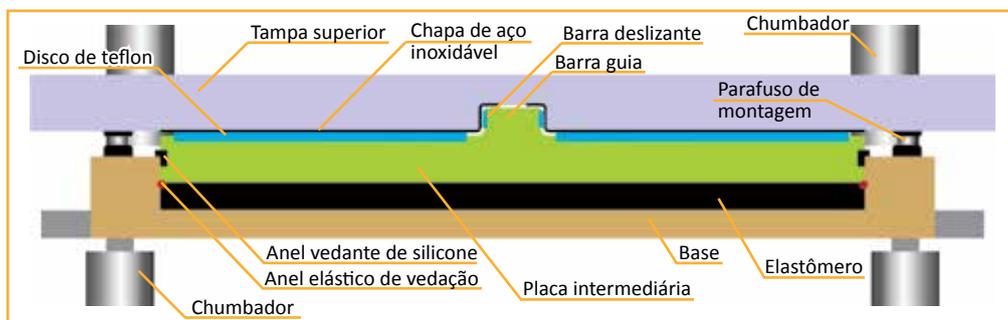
Corte transversal de um Aparelho Metálico Elastomérico Rudloff tipo Unidirecional-TU (fora de escala)
